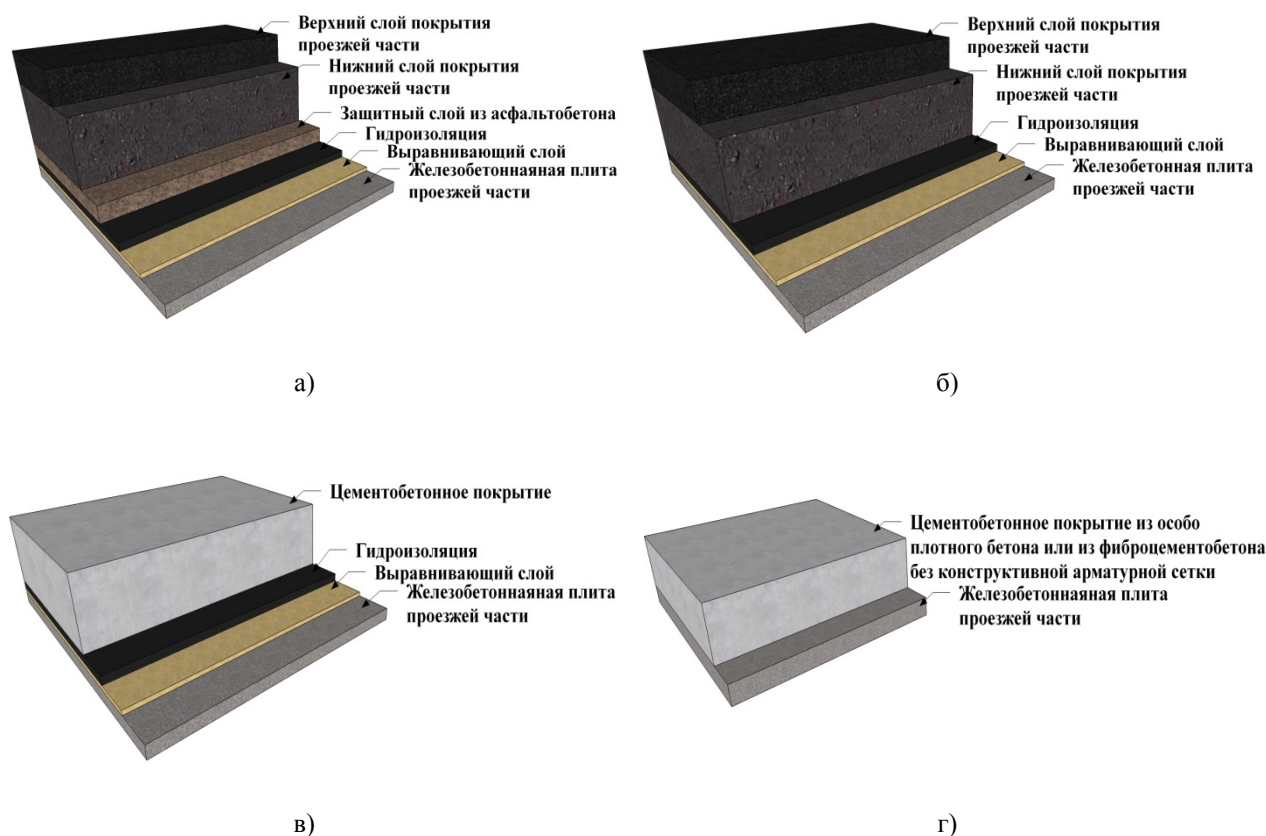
Конструкция одежды ездового полотна на железобетонной плите проезжей части мостовых сооружений: а) асфальтобетонное покрытие, уложенное на защитный слой из бетона; б) асфальтобетонное покрытие, уложенное на гидроизоляцию; в) цементобетонное покрытие; г) цементобетонное покрытие из особо плотного бетона, выполняющего гидроизолирующие функции, или из фиброцементобетона, поверх которых устраивается покрытие
